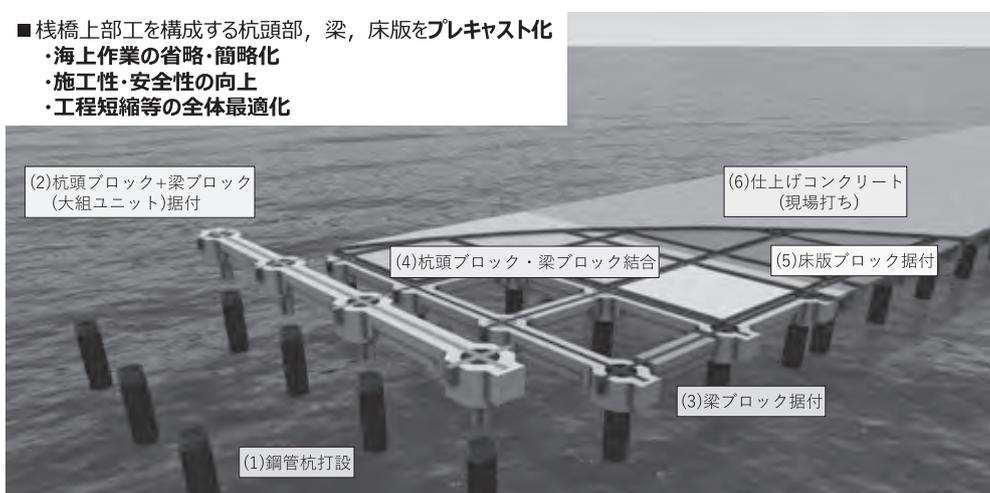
本工法の施工手順 ※図中の番号は施工順序を示す
